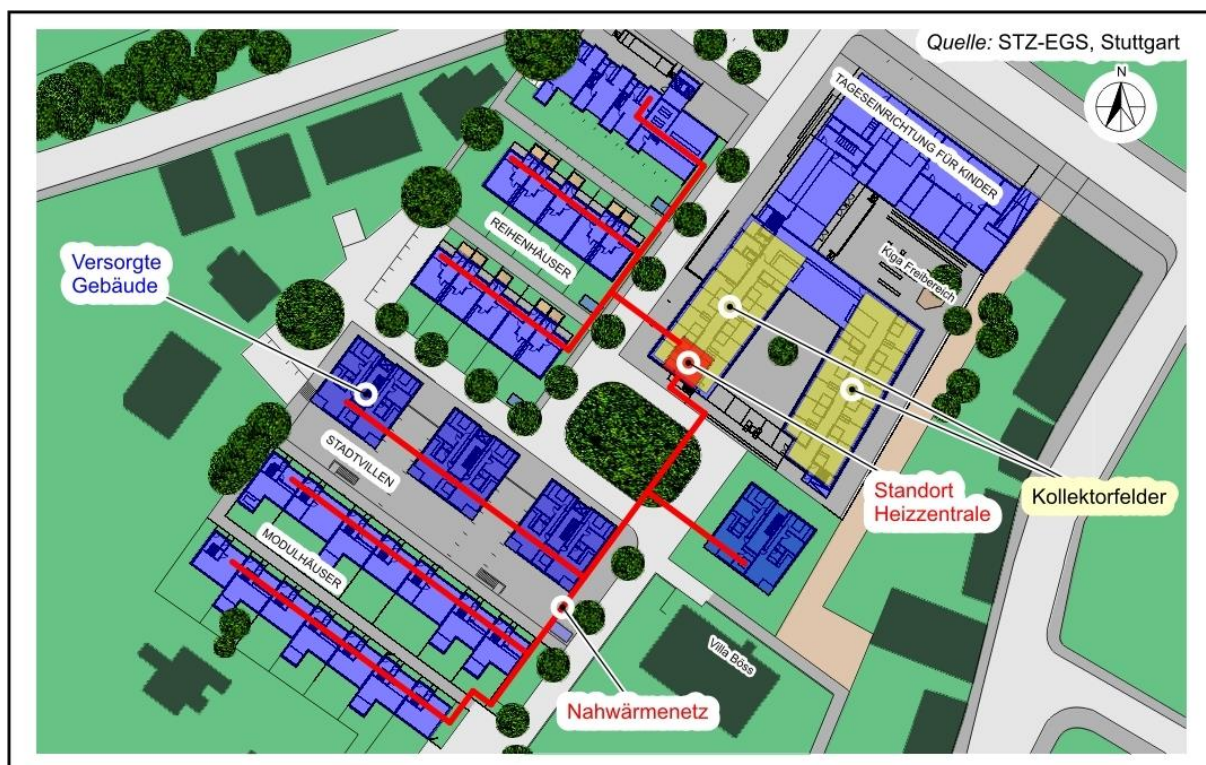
Lageplan Reutlingen, Wohngebiet Lindachareal
